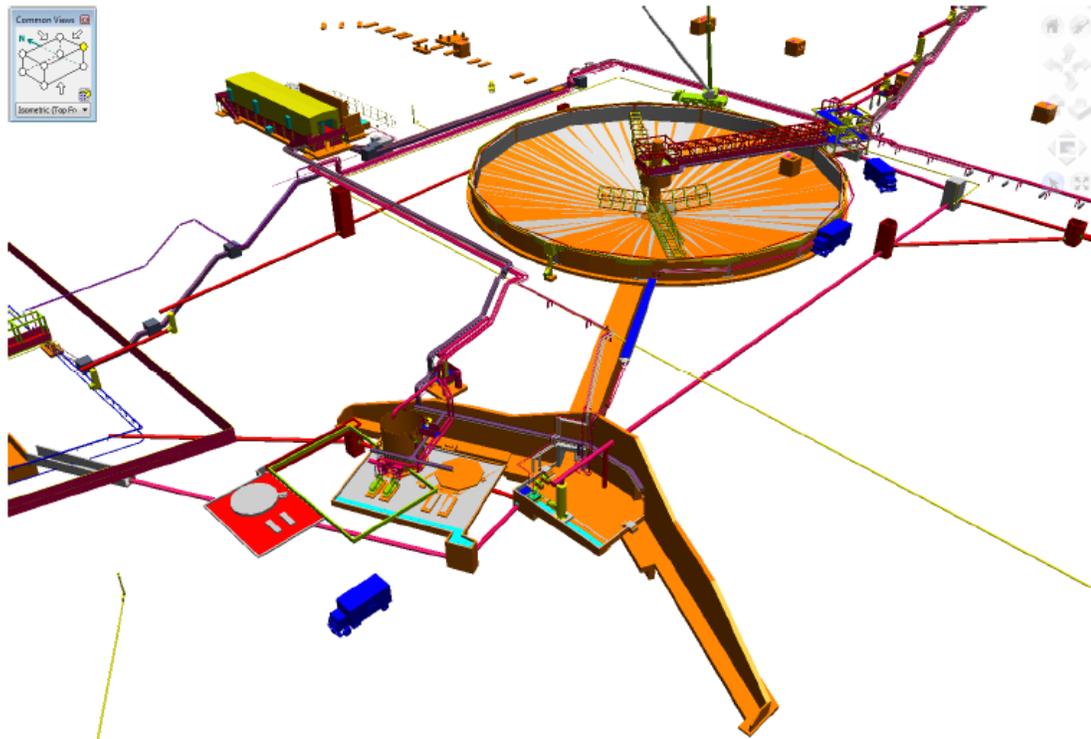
Vista de Estructura de Espesador de Concentrado Planta Concentradora
